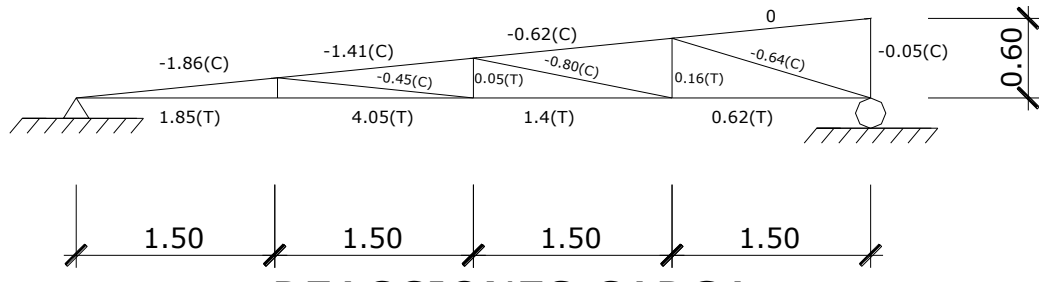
Reacciones internas de la carga viva de techo sobre la armadura.
